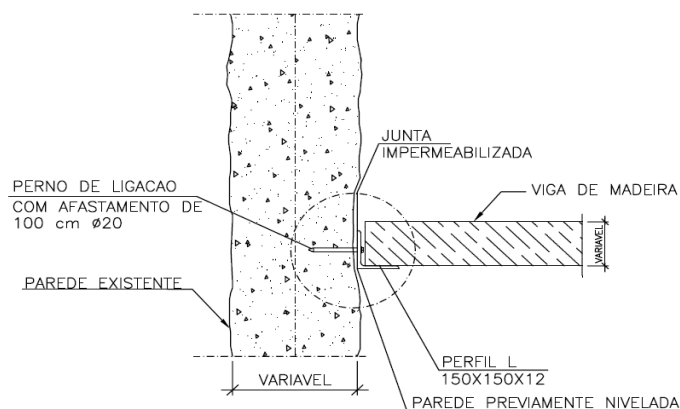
Pormenor de ligação dos pavimentos de madeira às paredes resistentes.
